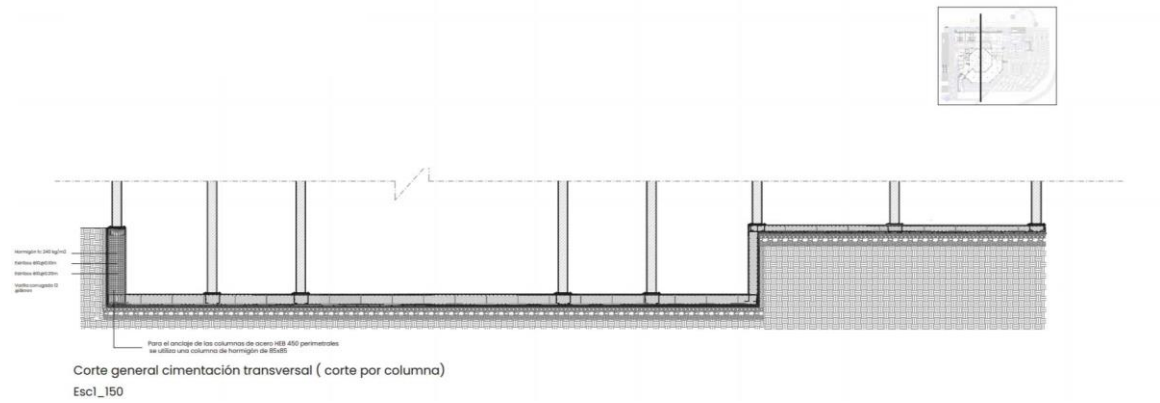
Corte transversal de cimentación Ramires S 2023
